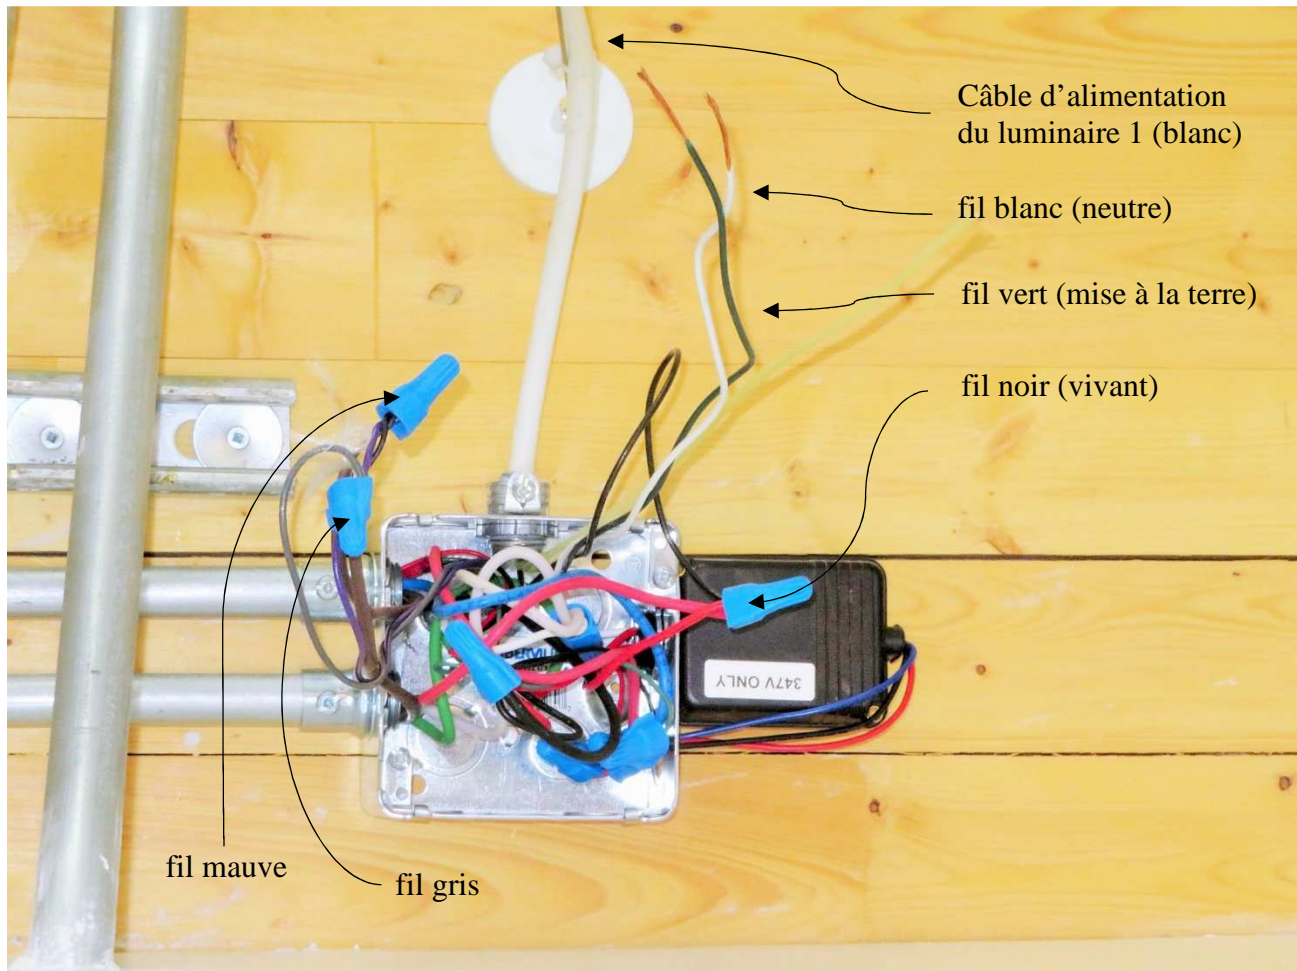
Raccordements du luminaire 1 dans la boîte de jonction
